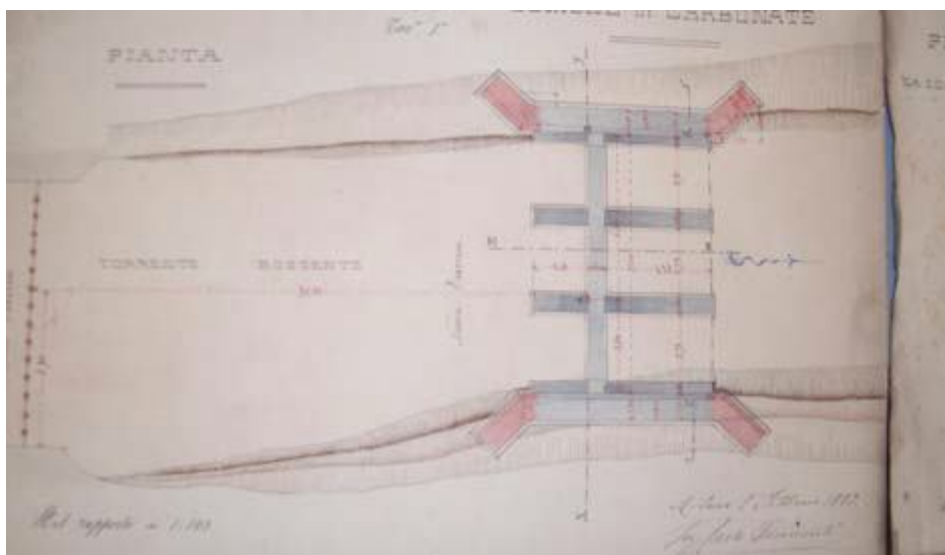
Pianta fondazioni di ponte sul Torrente Bozzente, Archivio storico Comunale di Carbonate, 1889.
